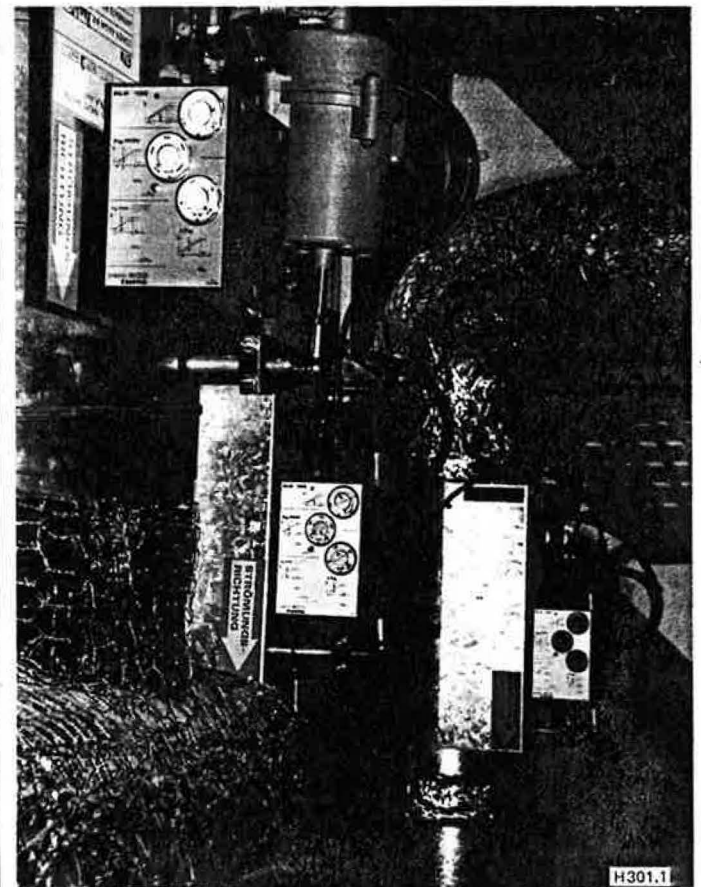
VAV-Regler in einer Lüftungsanlage montiert
